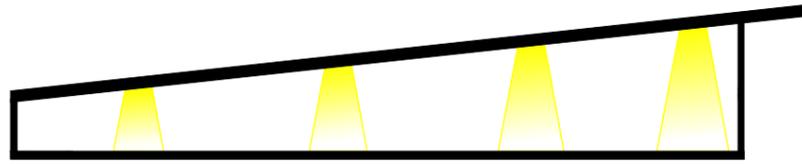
Schnitt Badehalle - Kunstlichtsystem Decke
